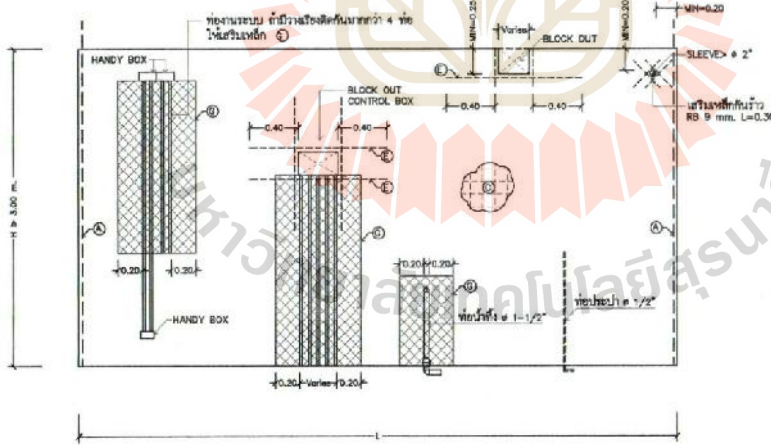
DETAIL (TYP. เสาเข็มเหล็ก TUNNEL แบบไม่มีช่องเปิด)
